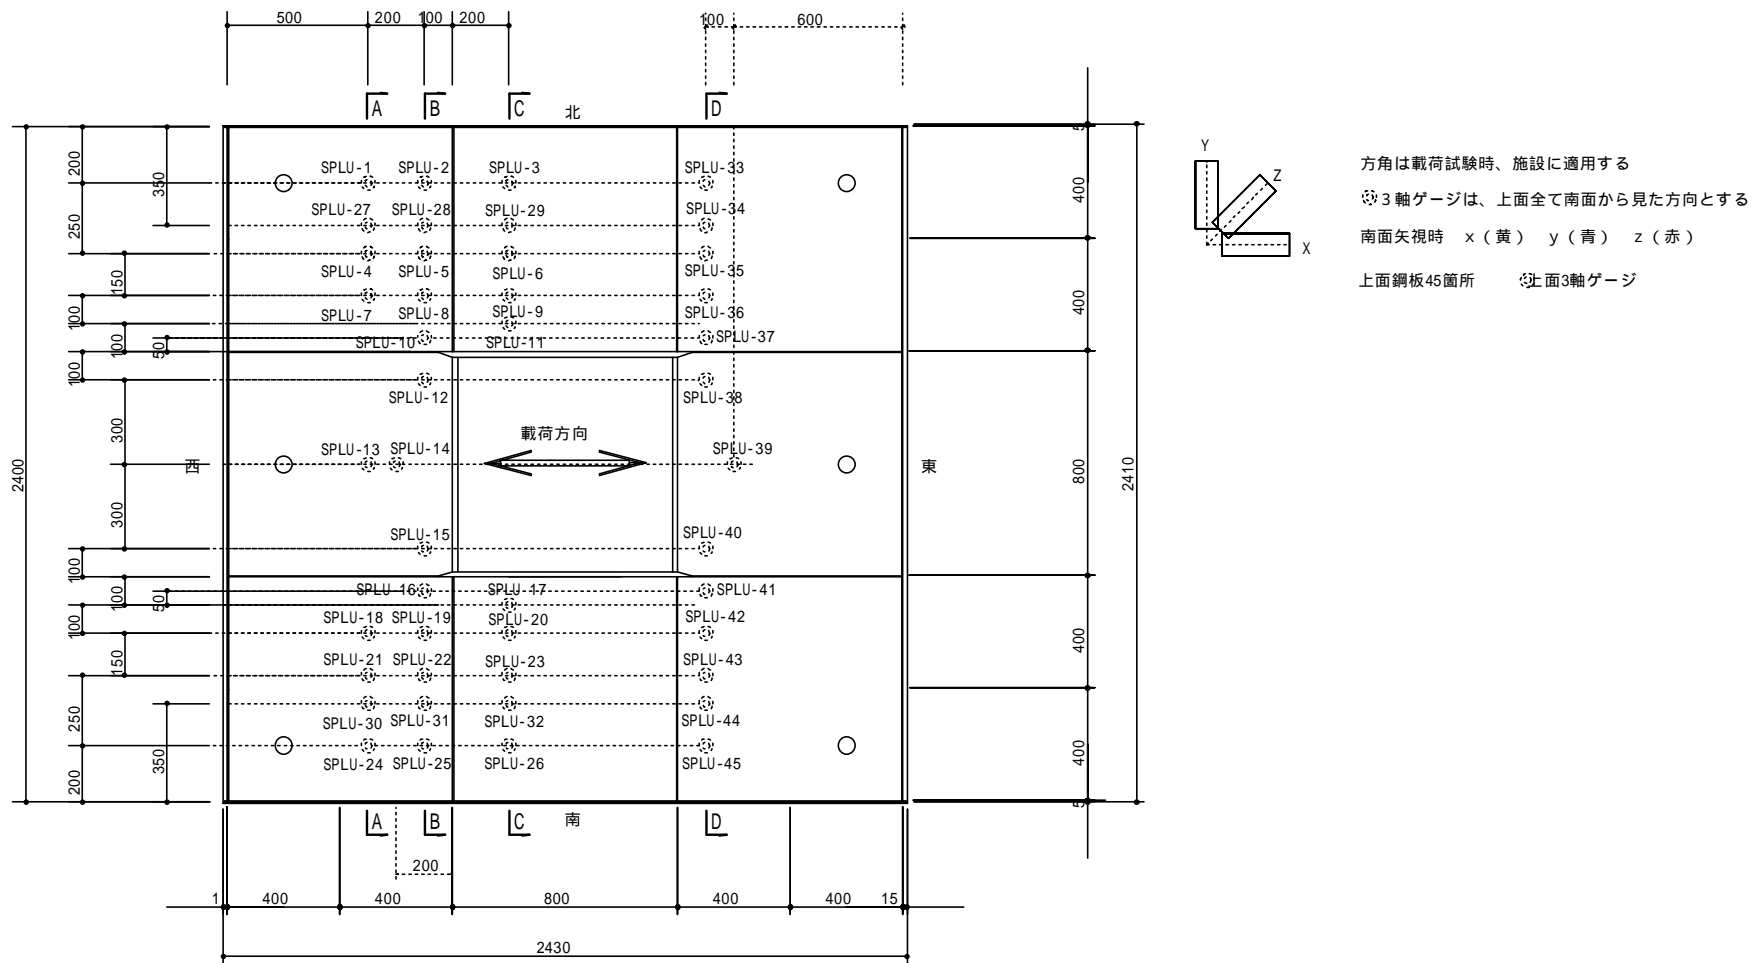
上面鋼板ひずみ計配置図 (F-2 試験体)
